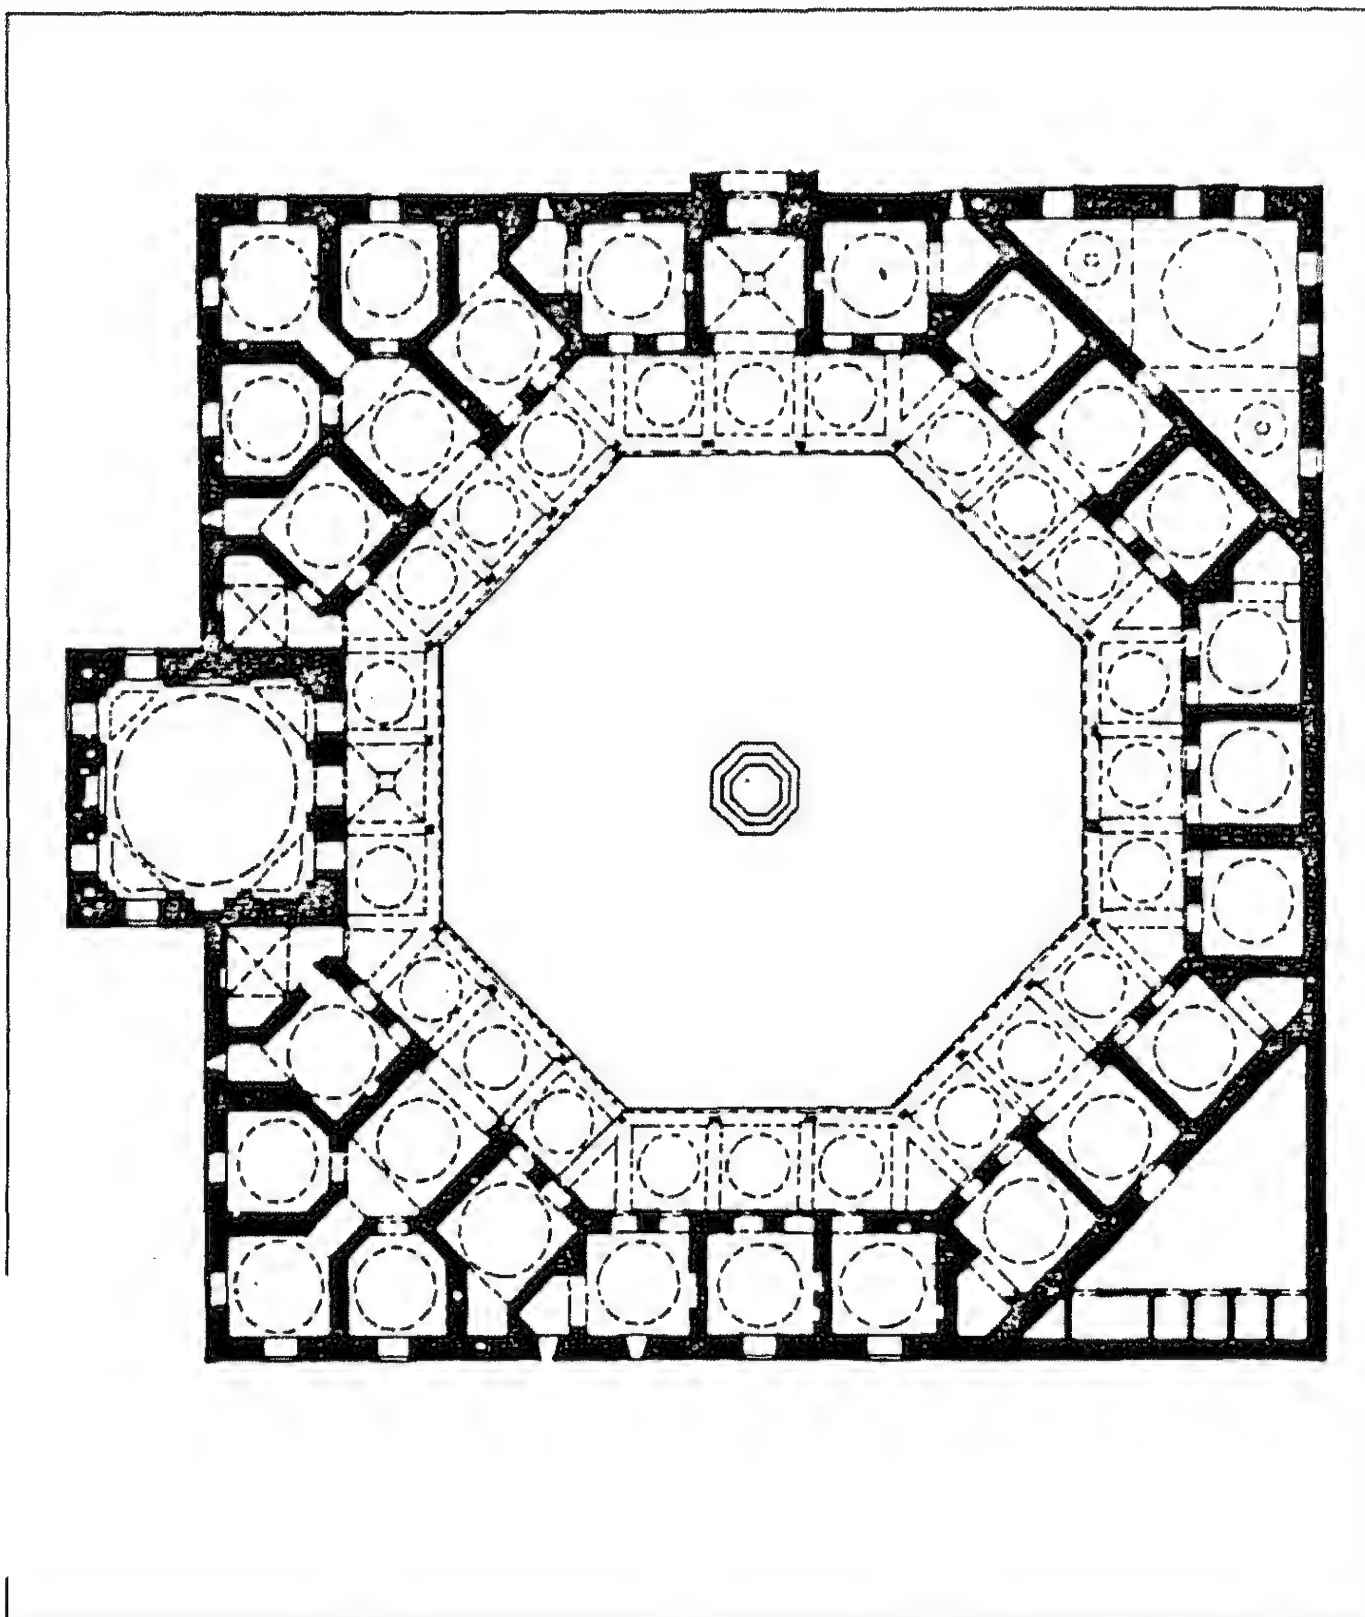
مسقط أفقي لمدرسة غازي خسرو بك في سرايفو (عن : إيفردى) .
